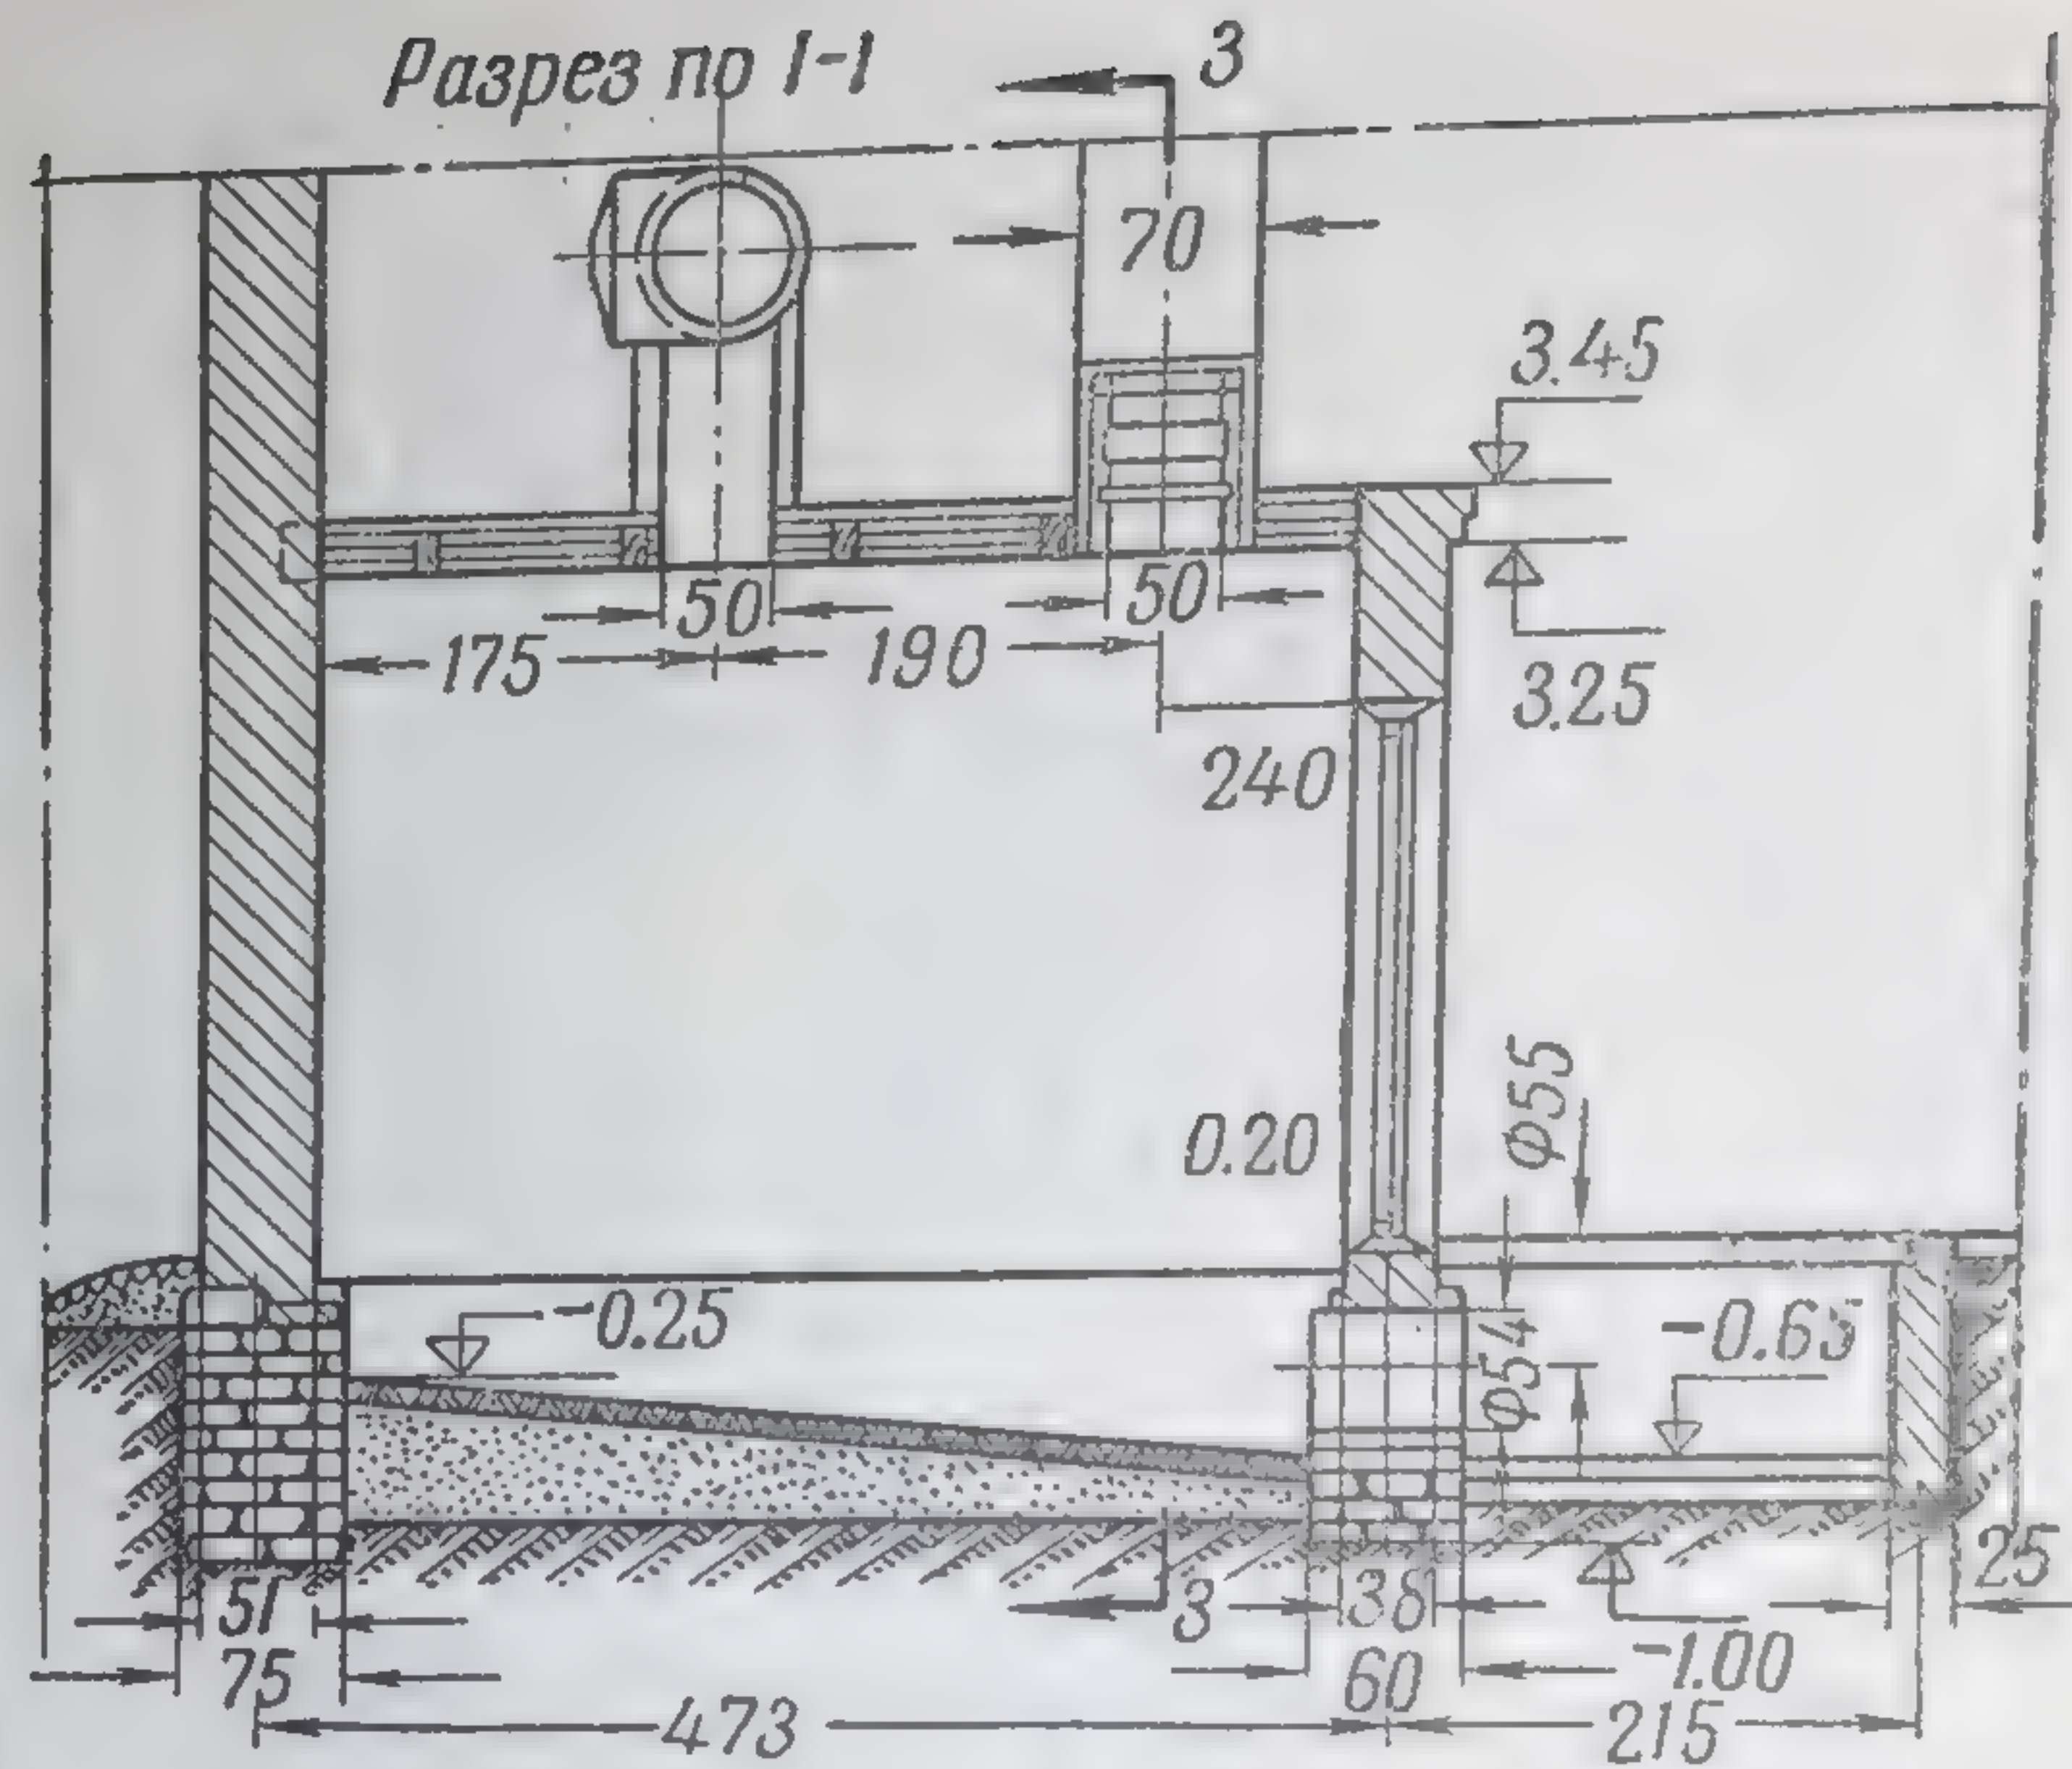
Паровая сушилка для конопляной тресты и зерна.
